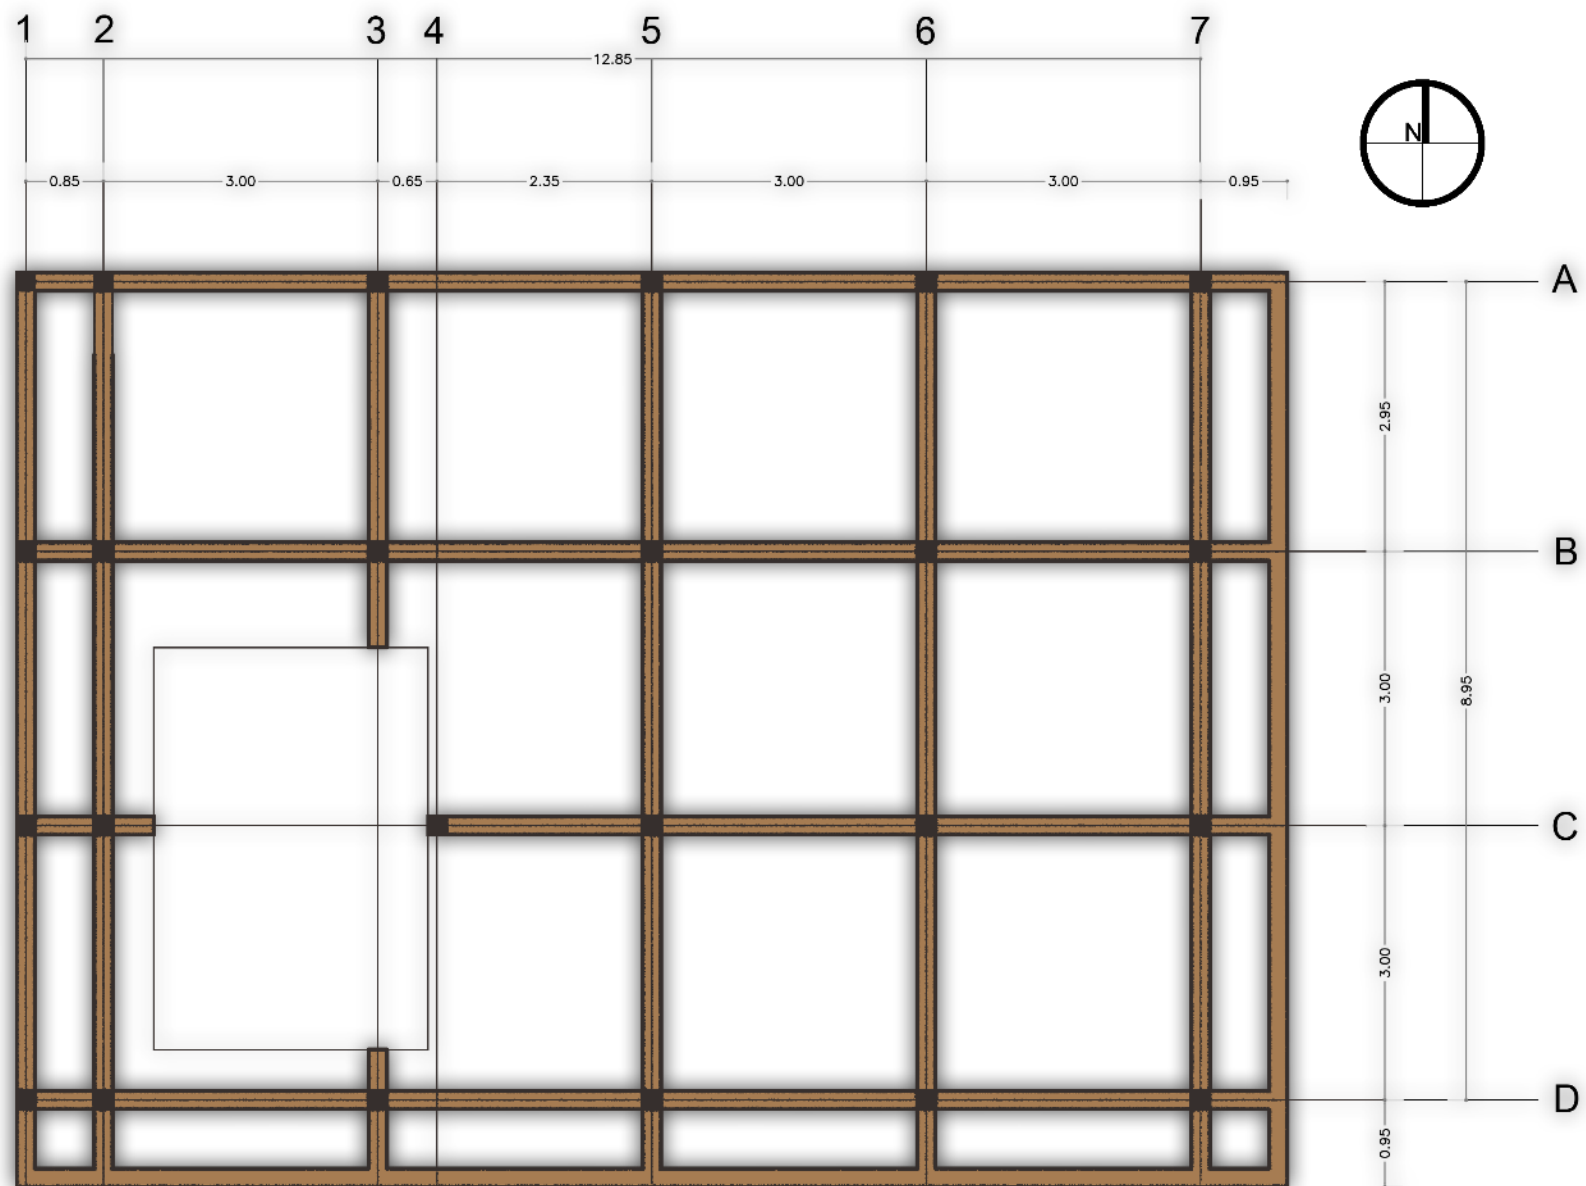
Planta estructural Vivienda modelo. Fuente: elaboración propia.
